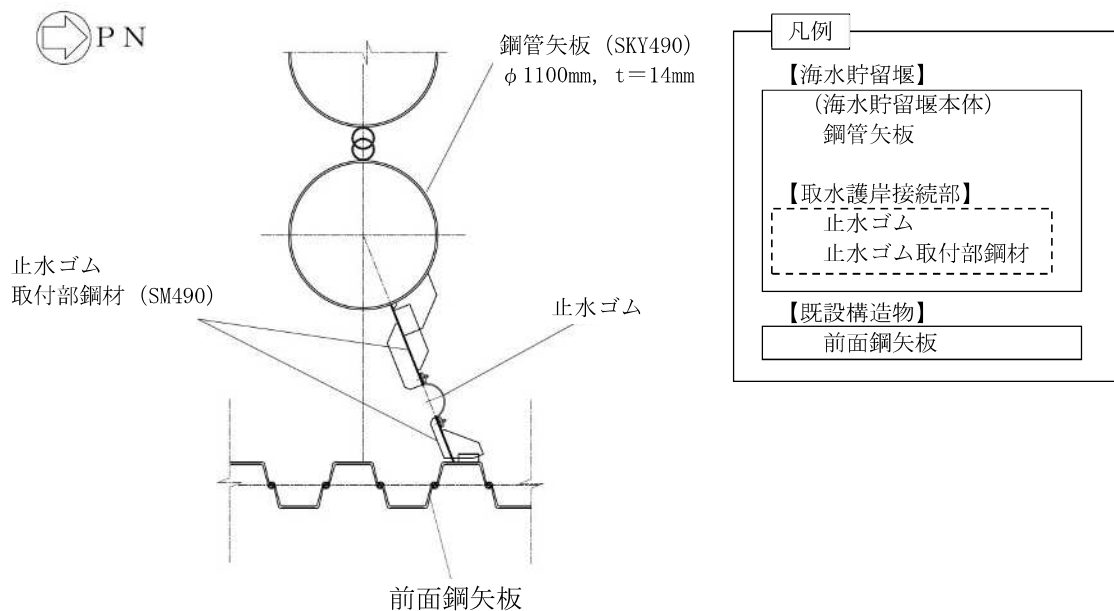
(2) 取水護岸の平面図 (A部拡大)
